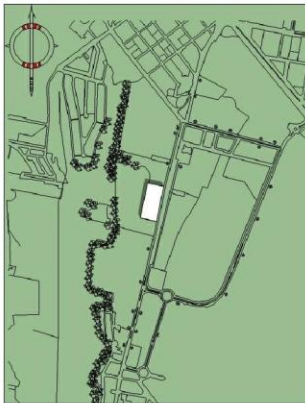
Soleamiento 06 de abril a las 12 p.m.
